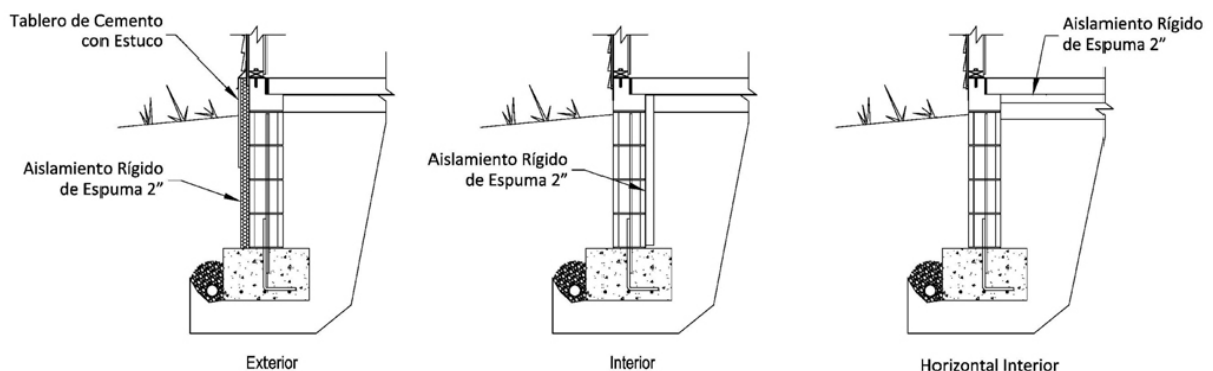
Opciones para la ubicación del aislamiento en la Losa
